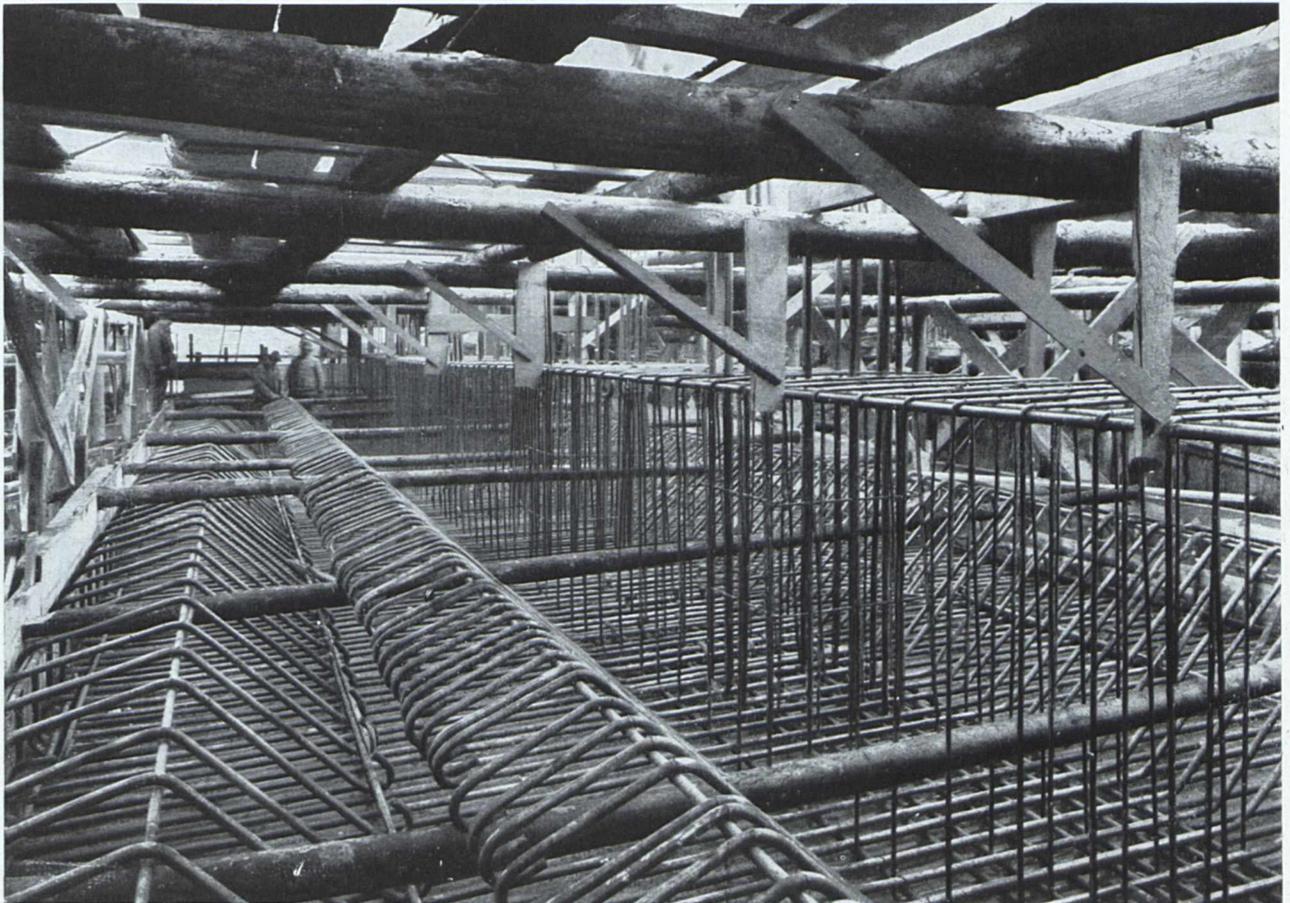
Bauausführung : Karl Stöhr, Bauunternehmung, München, Schwanthalerstraße 11
